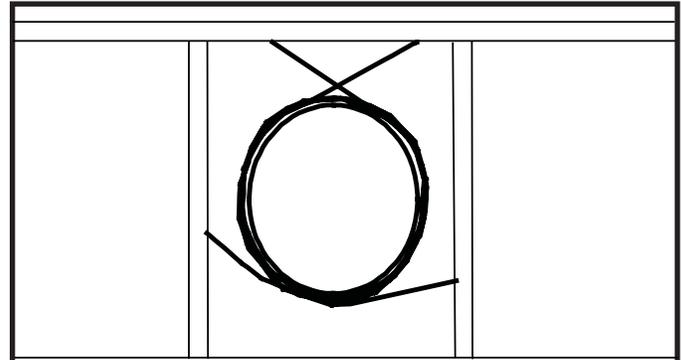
Sujeción de las secciones horizontales del tubo de escape
